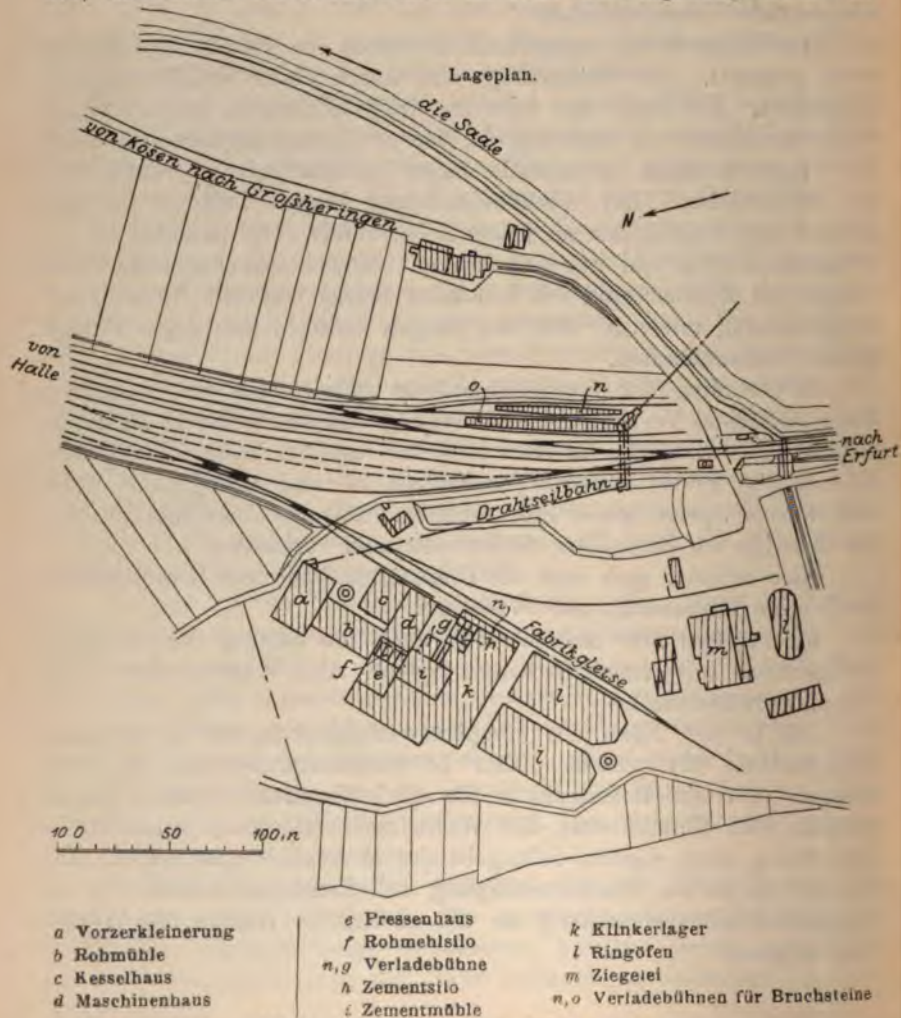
Lageplan der Zementfabrik Rudelsburg.
